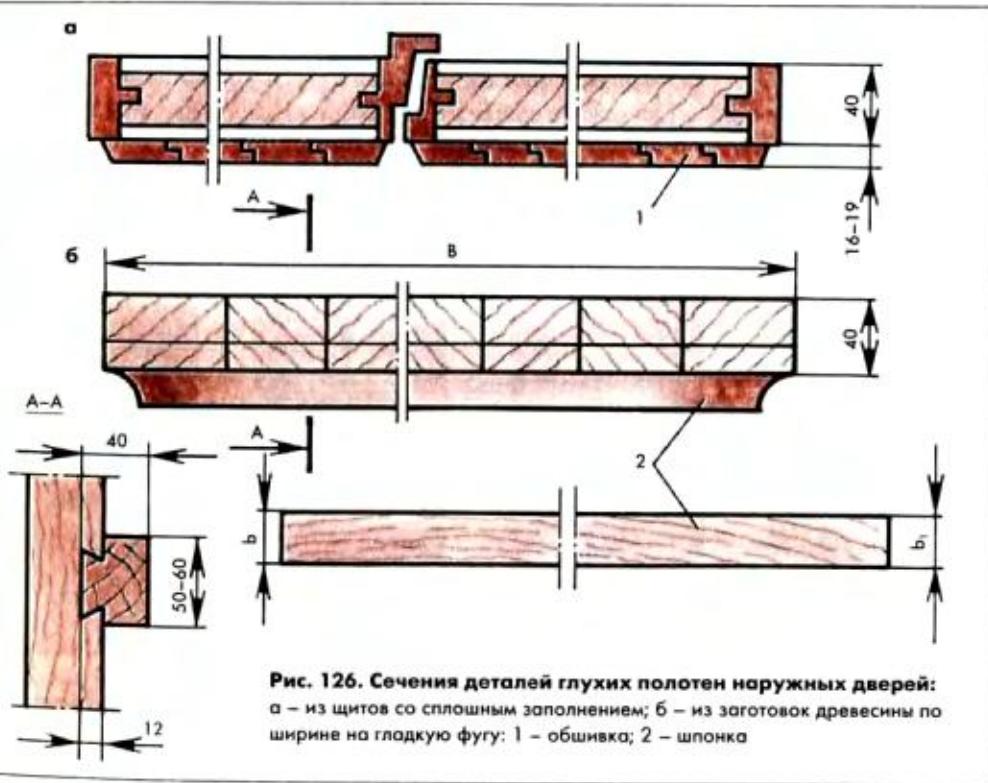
Сечения деталей глухих полотен наружных дверей:
